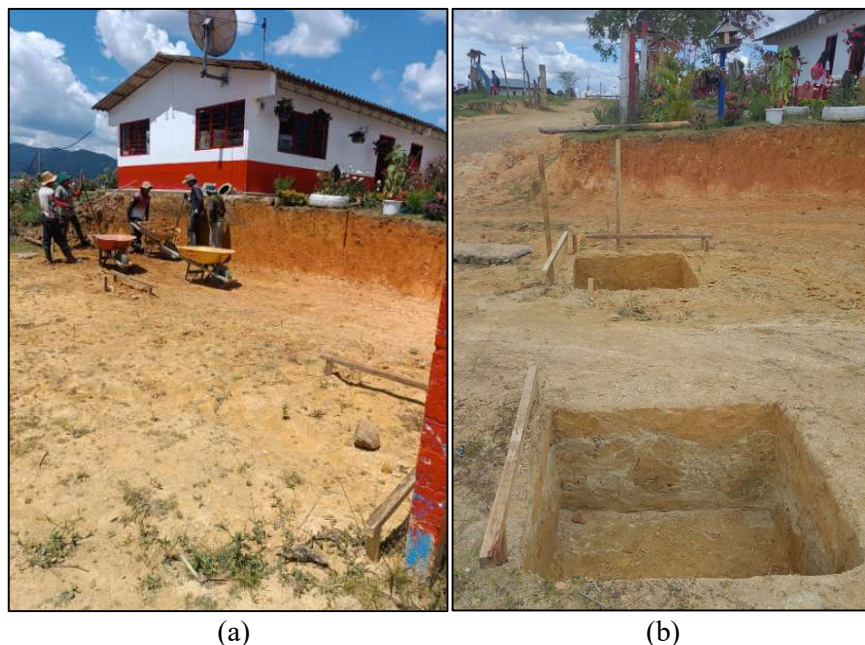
Estado del proyecto al inicio de la pasantía.
